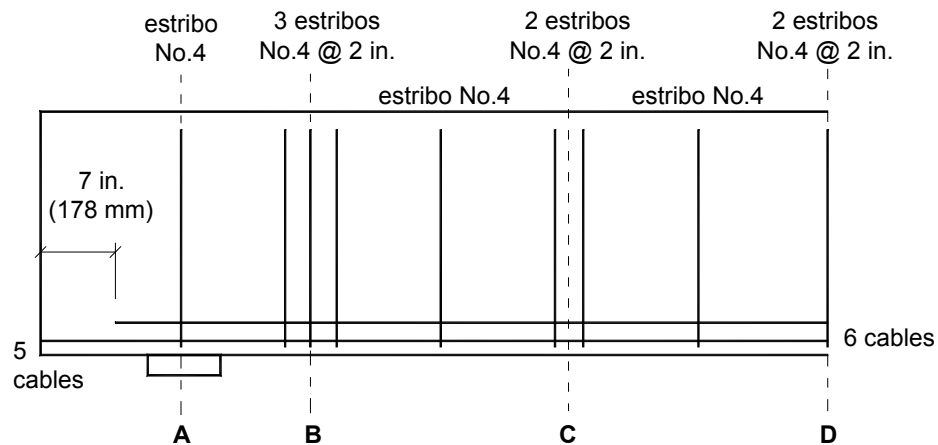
Configuración de las armaduras para la región del extremo de la viga
